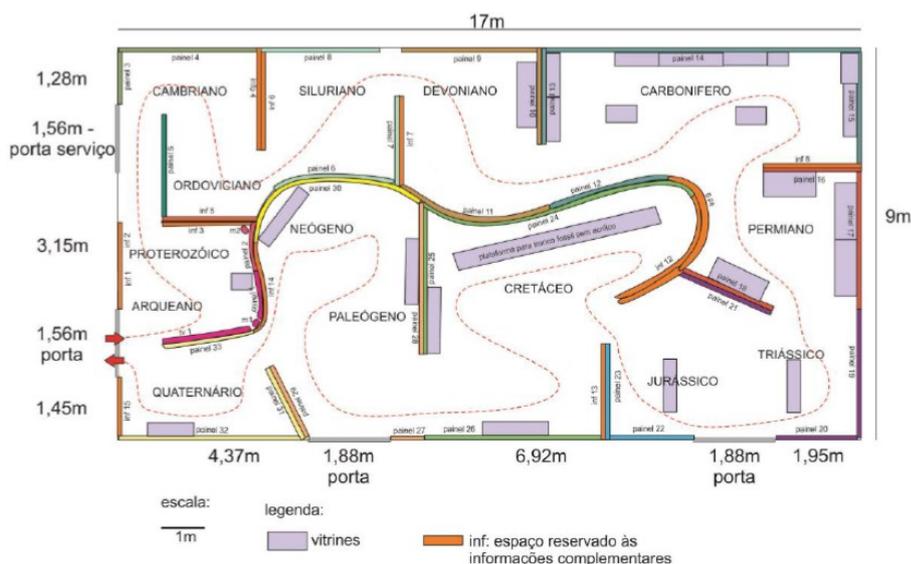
Planta baixa da exposição conforme foi apresentado à FAPERJ.
